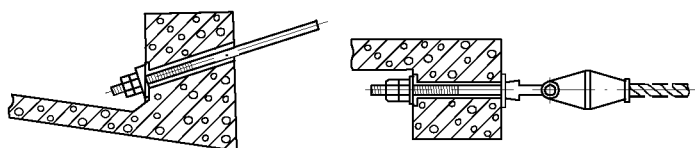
Узлы крепления вант к бортовым элементам покрытий
